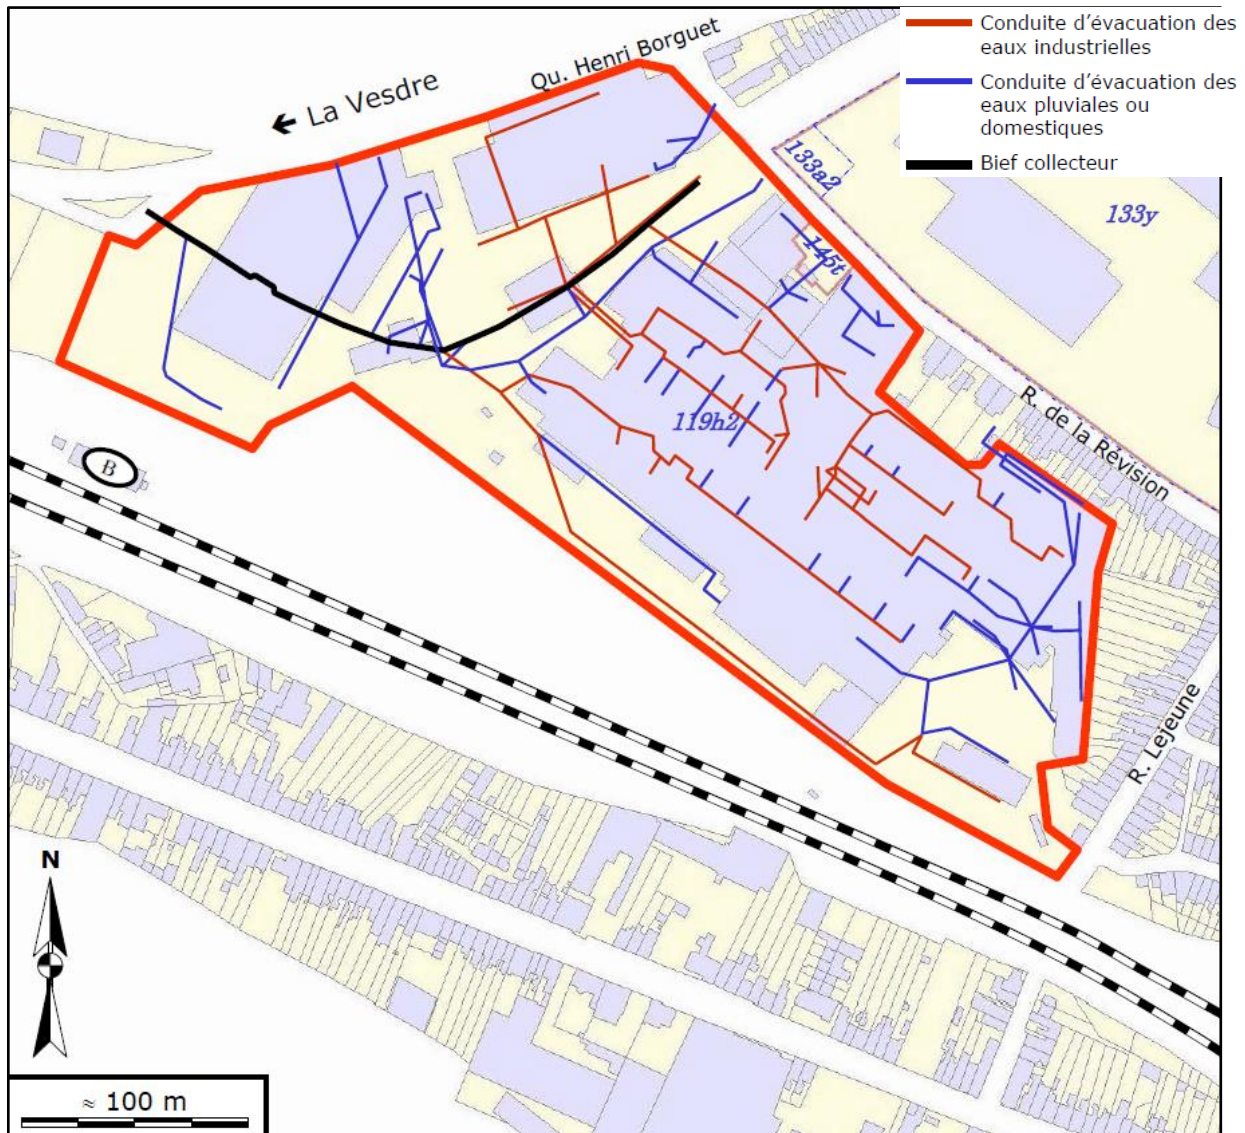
Réseau d'égouttage historique du site LBP et position du bief
